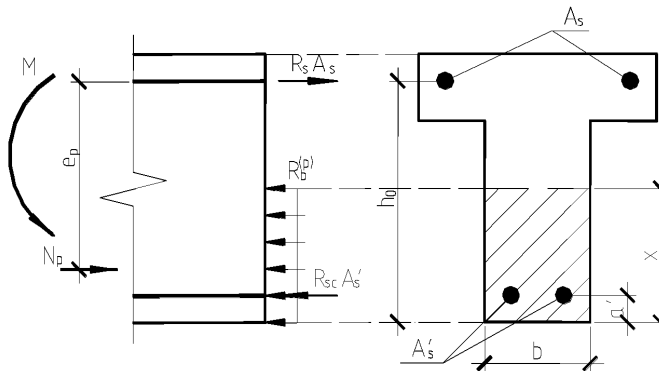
Схема усилий в поперечном сечении железобетонного элемента с прямоугольной сжатой зоной в стадии предварительного обжатия
